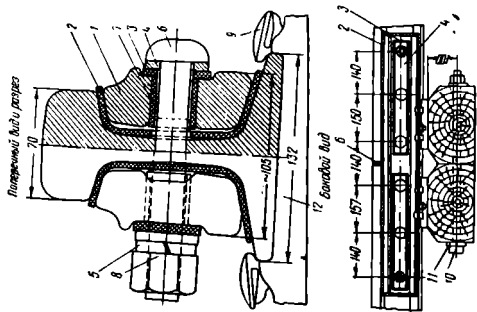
Изолирующий стык для рельсов Р50 с металлическими накладками
